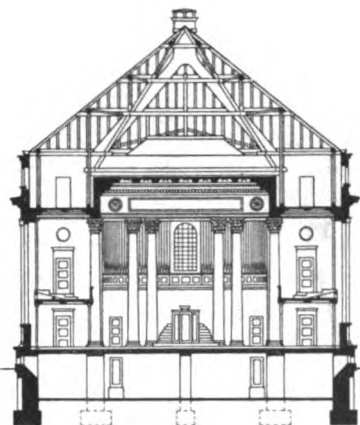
bis 20. Grundrisse und Querschnitt. — 1:500.
